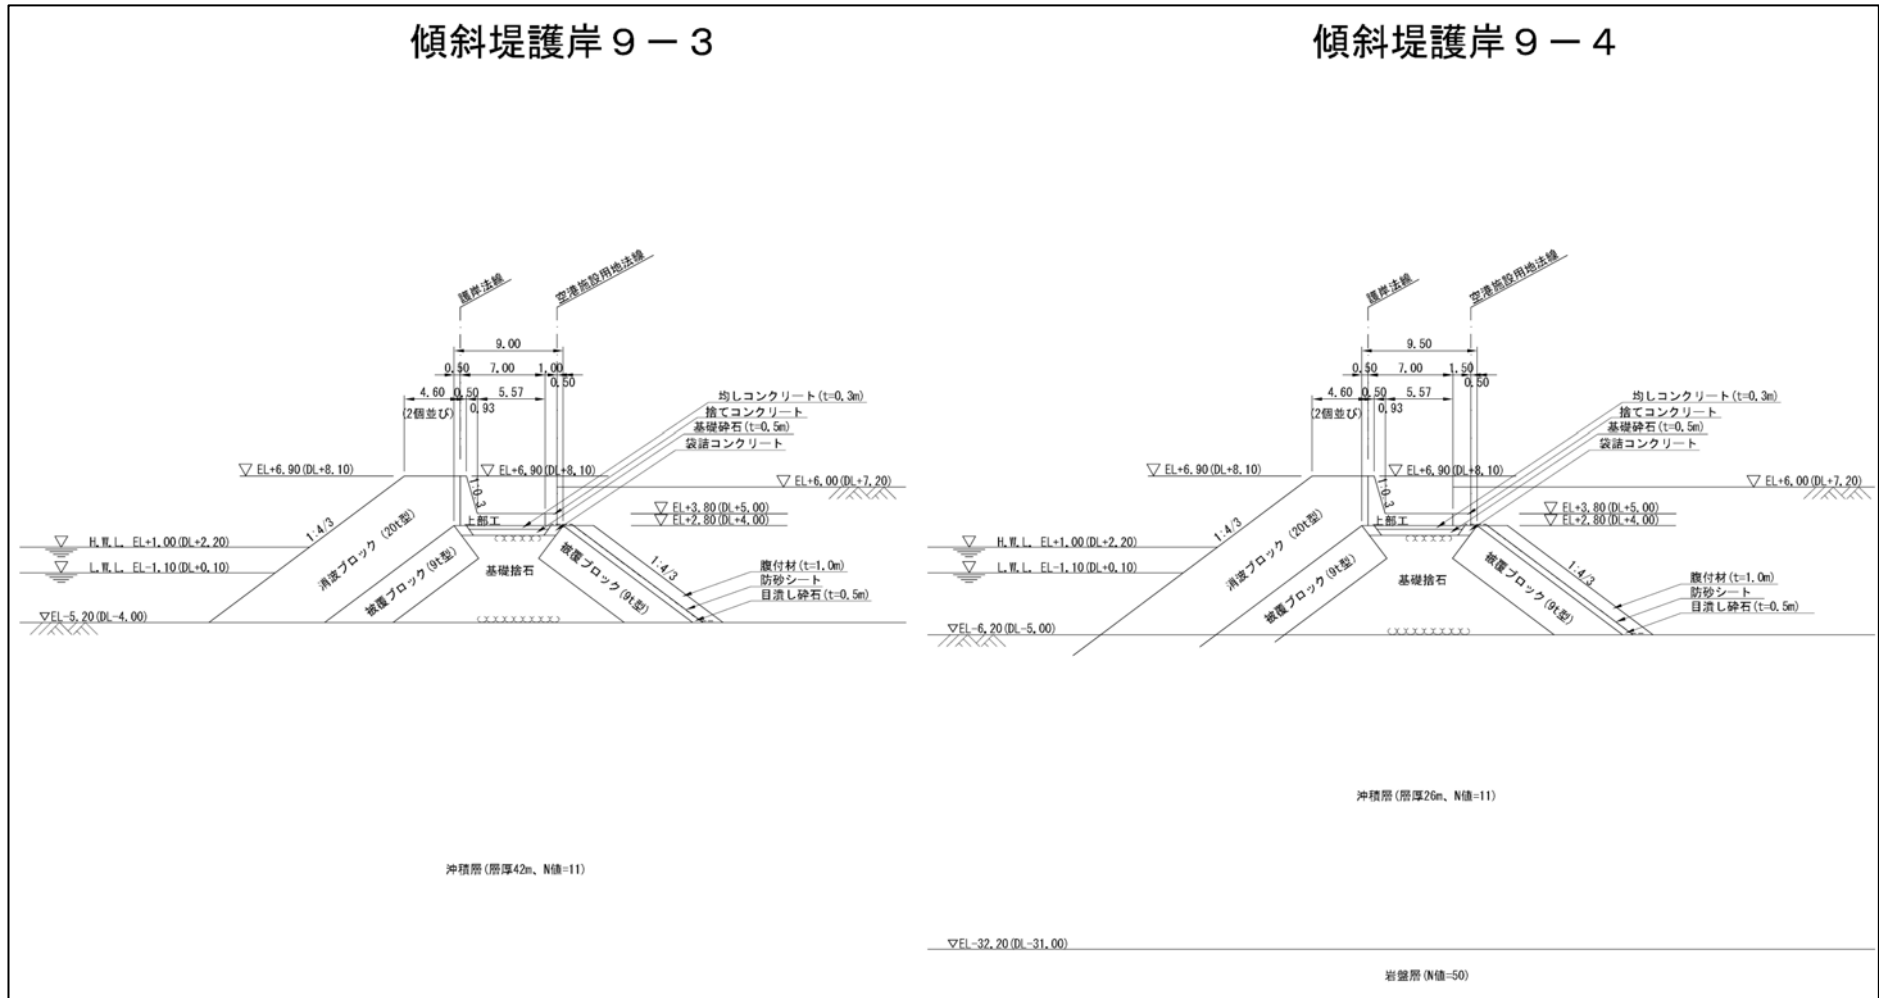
(10) 代替施設本体の傾斜堤護岸断面図
